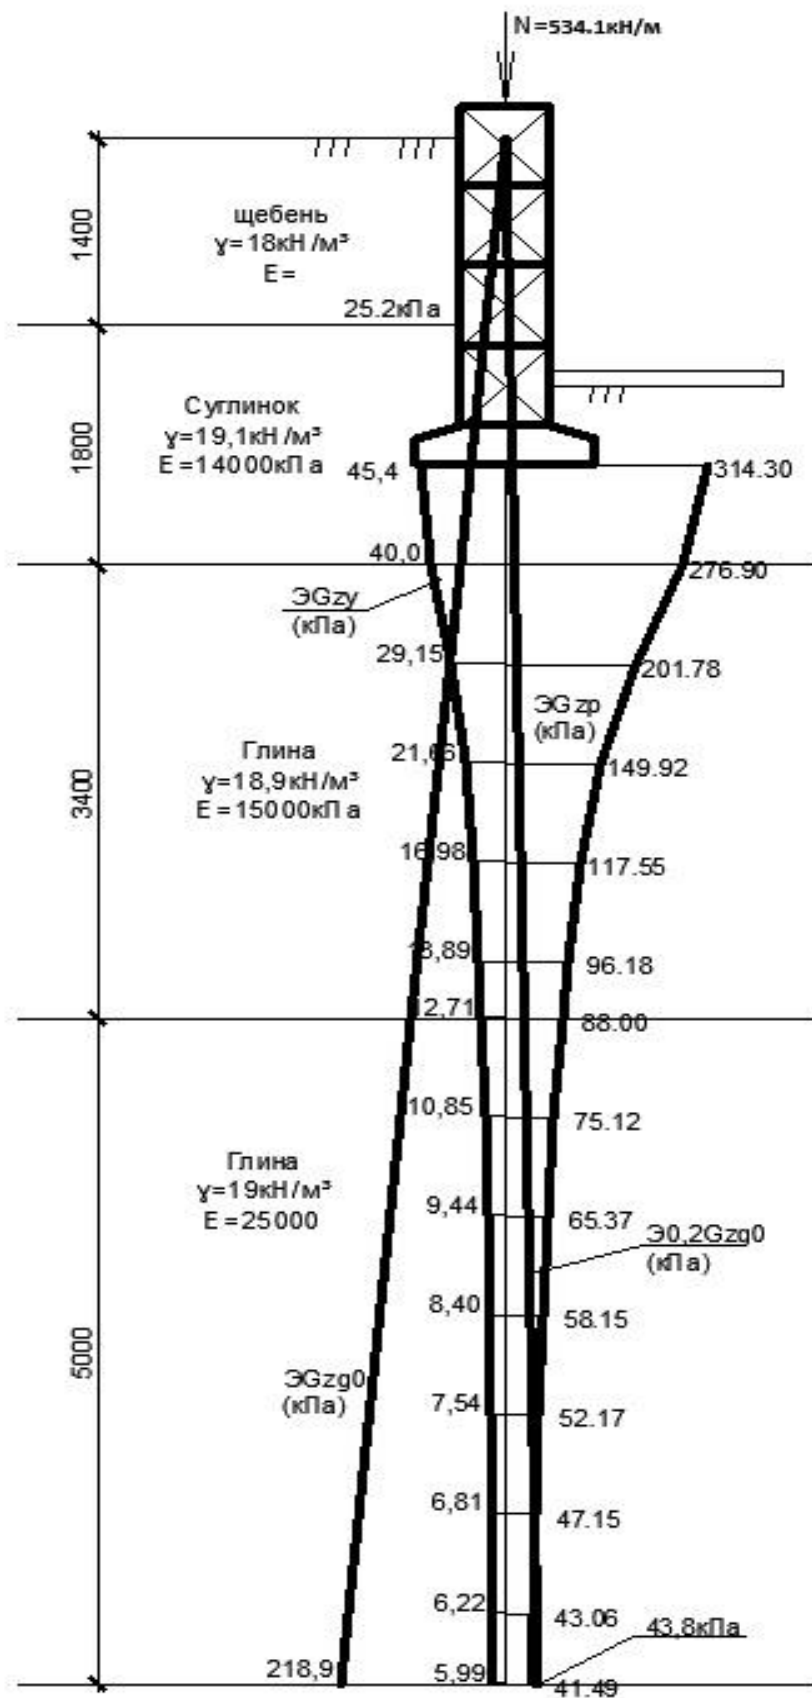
Схема к определению осадок фундамента «13» – «14»/«Л»
